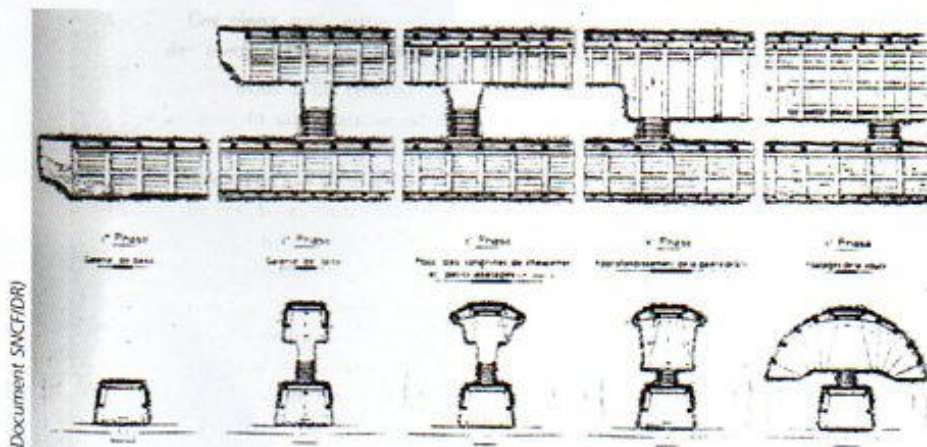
Coupe longitudinale, Tunnel de l'Ave Maria
